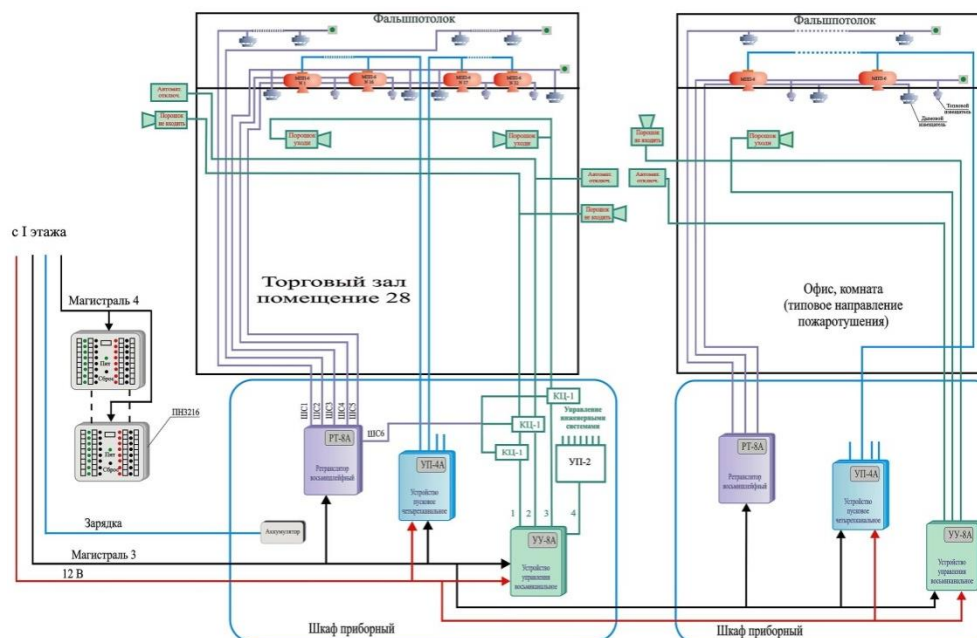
Схема размещения модулей порошкового пожаротушения на 2 этаже здания
